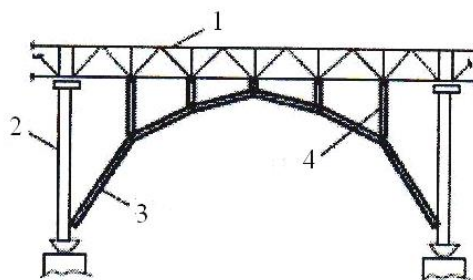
Усиление стропильных ферм путем установки поддерживающей арочной конструкции:
